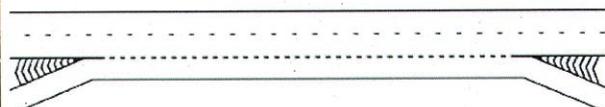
exemple de voie d'entrecroisement entre une entrée et une sortie
